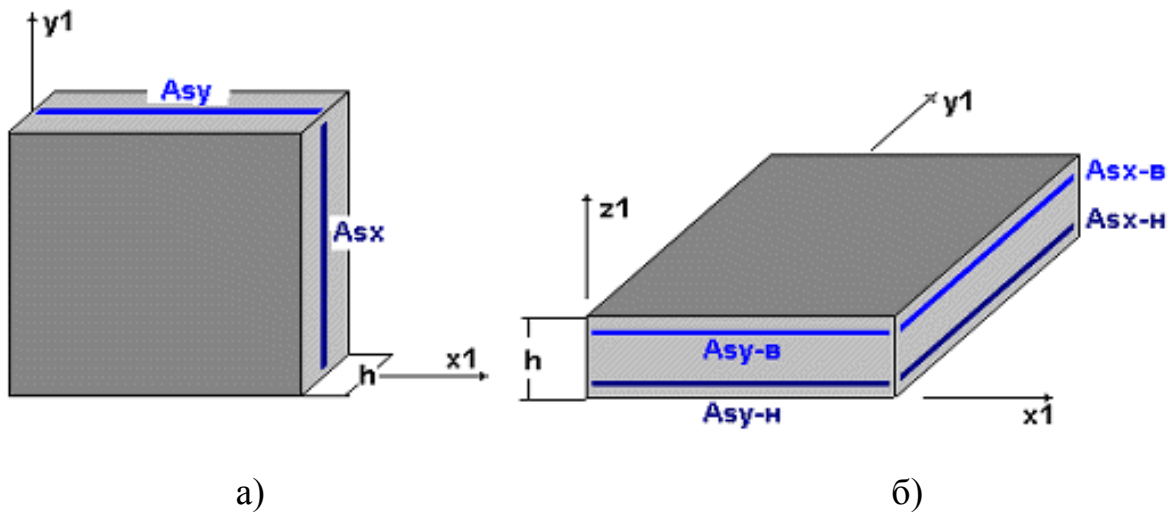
Схеми розташування поздовжньої арматури:
